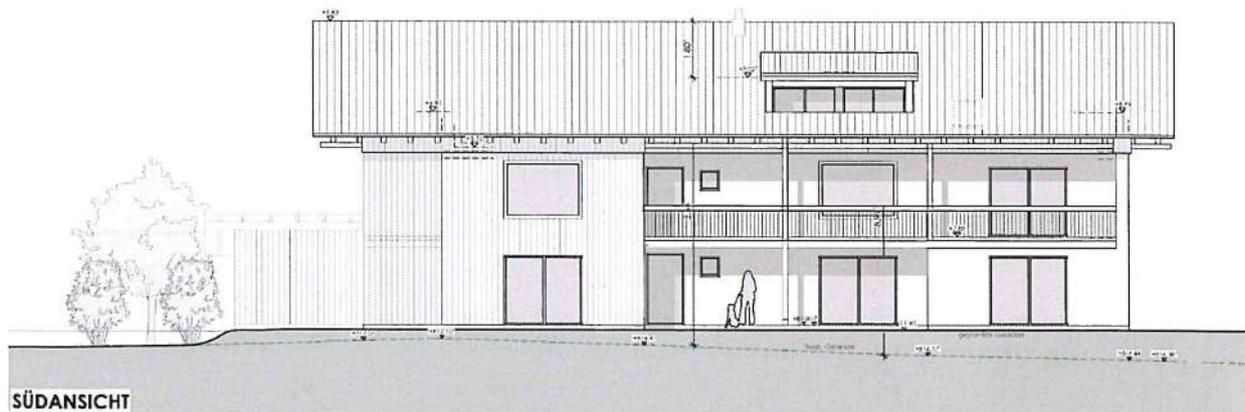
Vorentwurf Gebäude – Südansicht, © Atelier XVS, Pfronten-Meilingen Juni 2022
